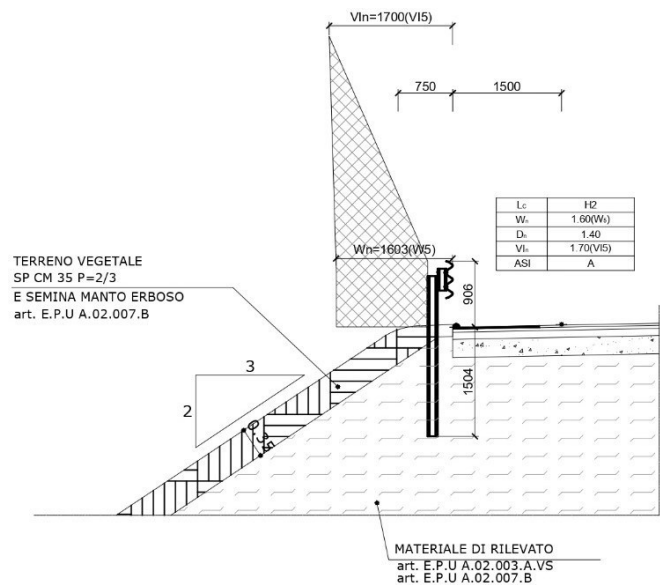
Schema di installazione impianto “tipo” senza ostacolo fisso.
